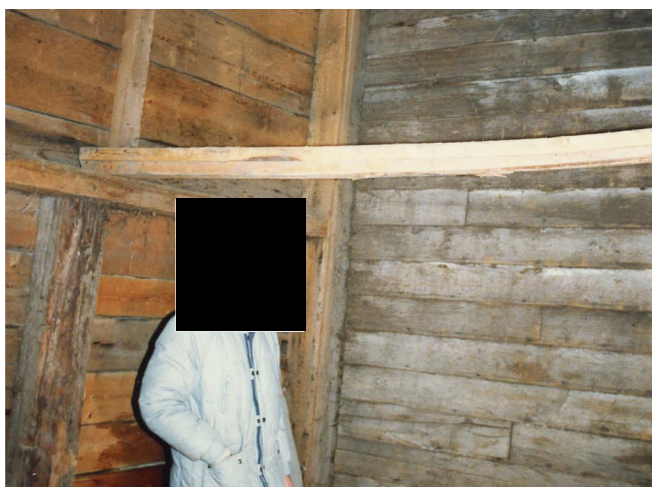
Structure des murs du bâtiment composée de poutres et de colonnes de bois. Travaux de restauration de 1988. Source : Collection du SHNP.
